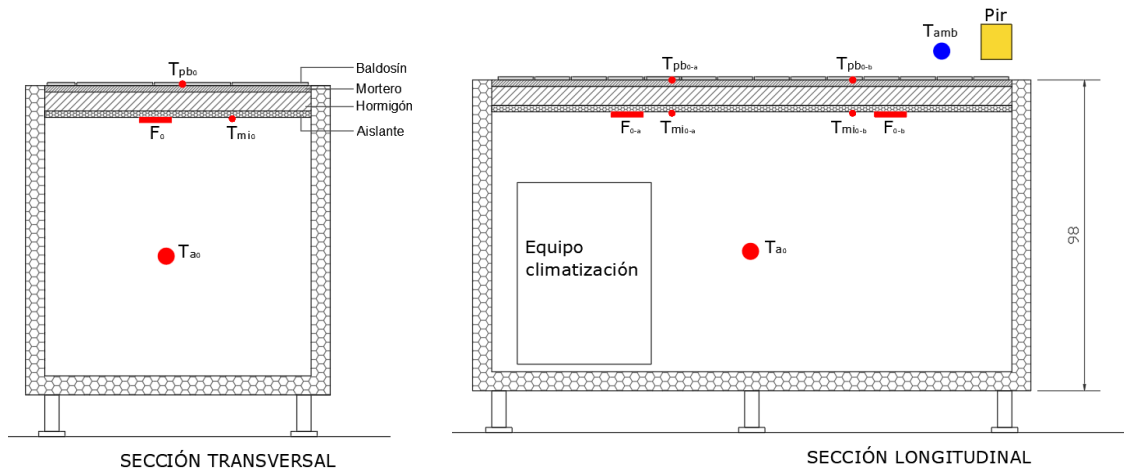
Sección transversal y longitudinal con detalle de los sensores instalados
